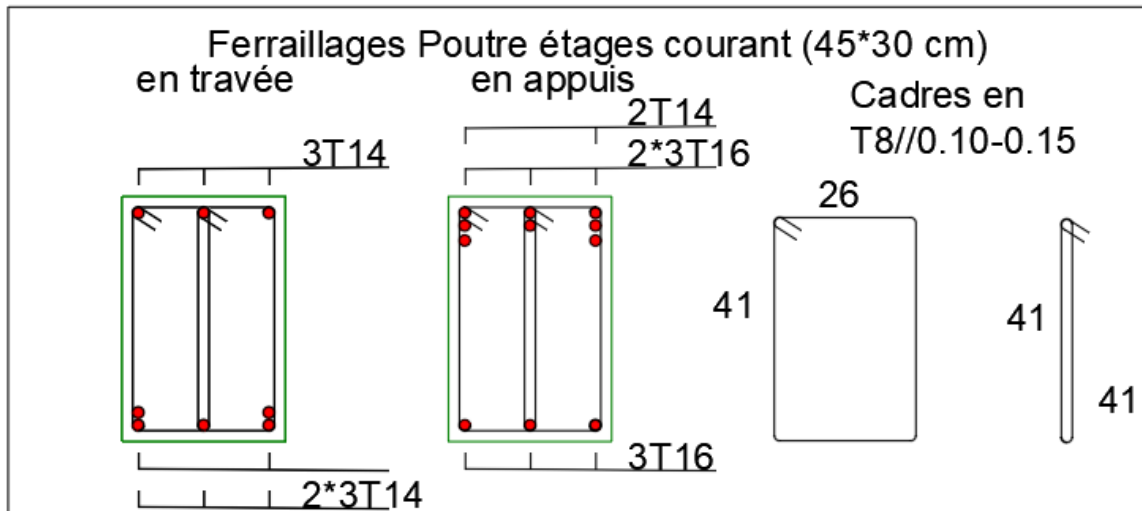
Ferrailages Poutre étages courant 45\*30 cm.
